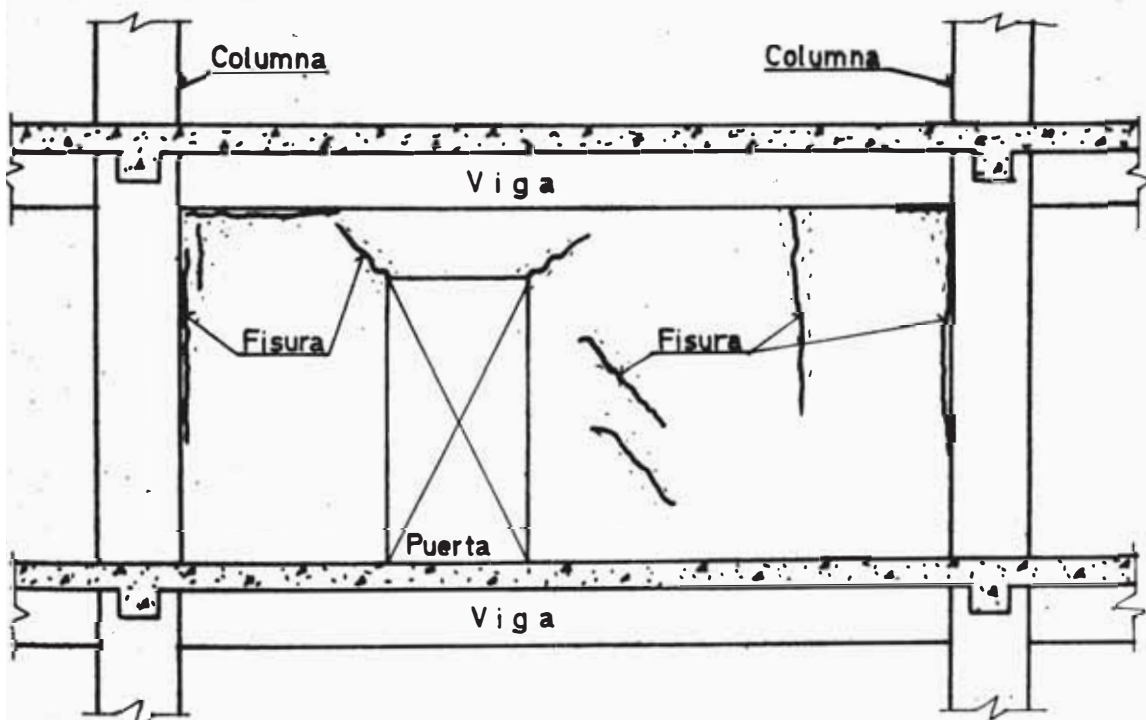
a : Fisuras y algunas grietas en tabiquerías de entrepisos superiores-Direcciones principal y secundaria-Algunas de tracción diagonal.Pabellon Central.
